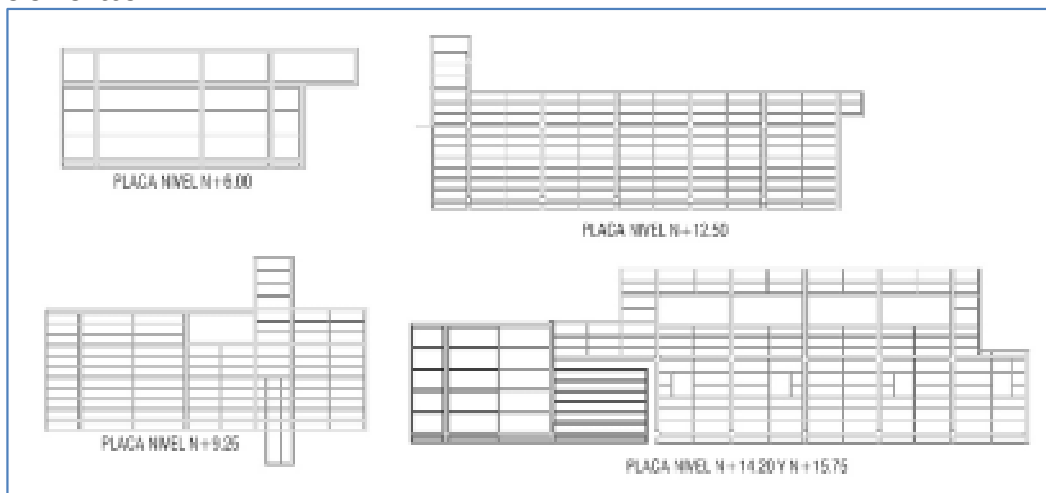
Volúmenes de placas en concreto (vigas viguetas y placas macizas).
